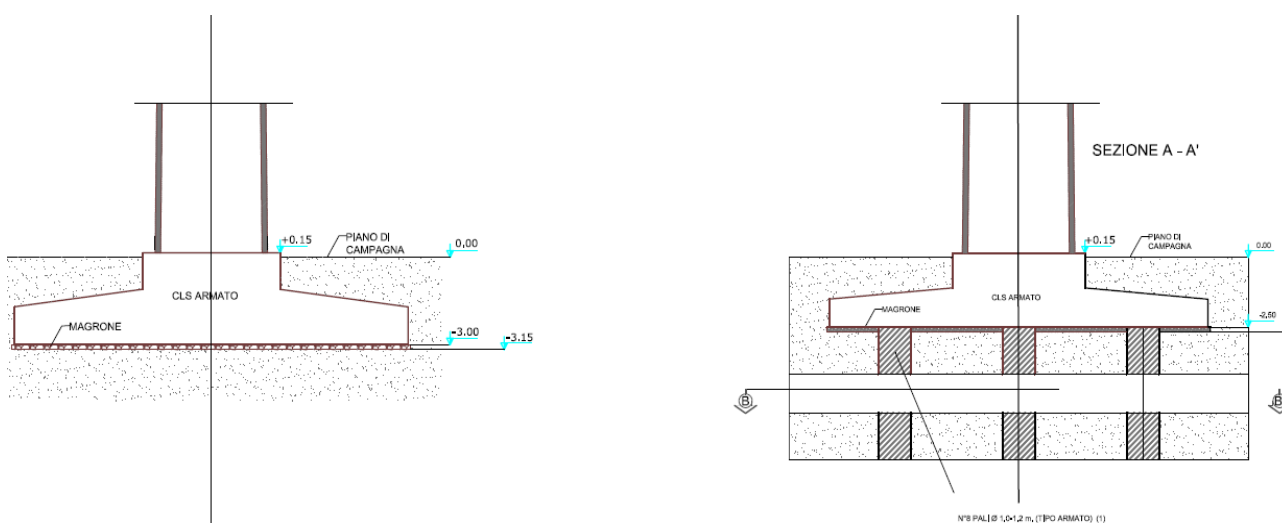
Tipico sezione fondazione (diretta e a pali)
